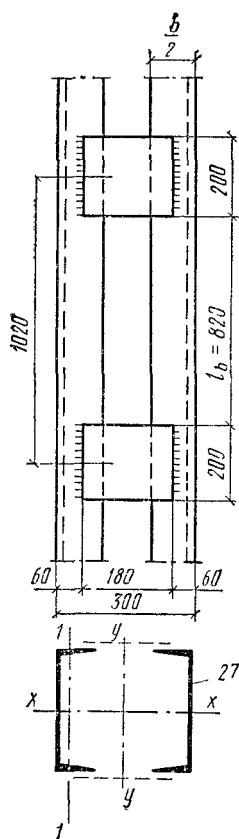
Стержень колонны с планками к примеру 8.2
